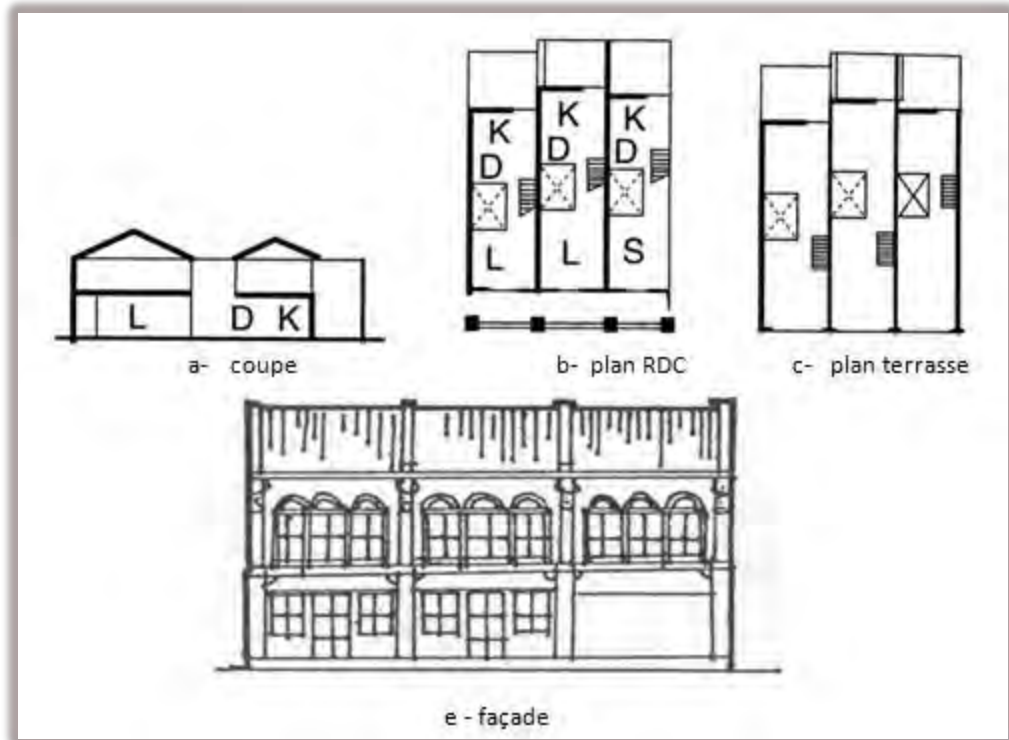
Plan, coupe, et façade typique de la conception des maisons magasin en Malaysia et Singapore.
